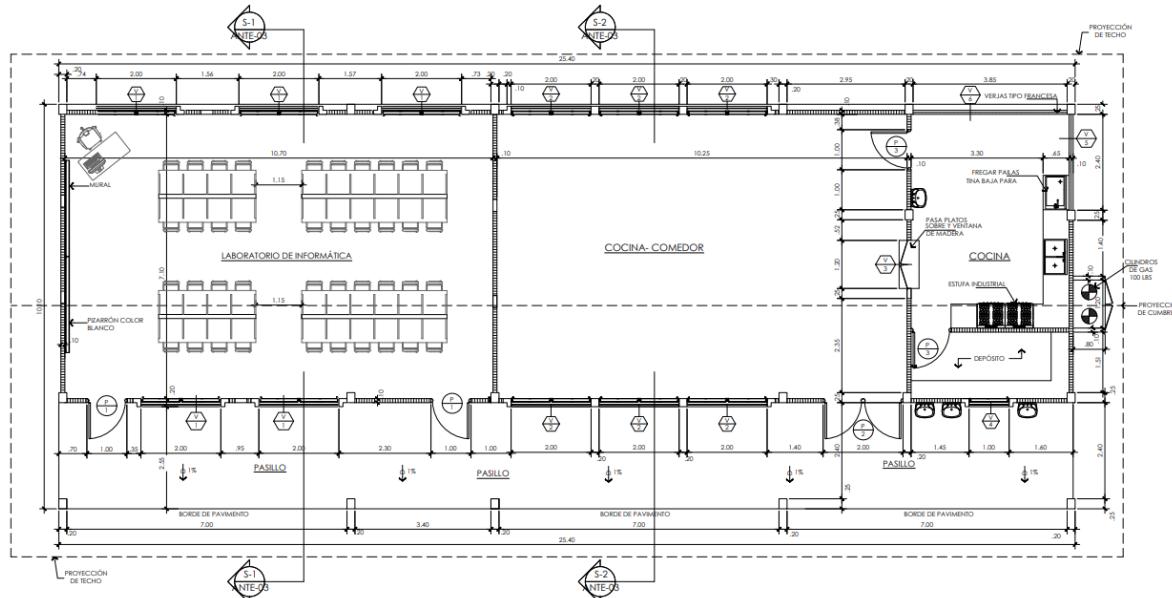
Planta Arquitectónica del Centro Educativo Ipetí Choco
